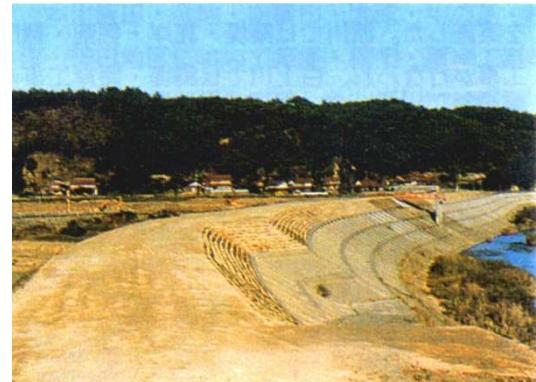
白上川堤防の施工状況（昭和55年）
